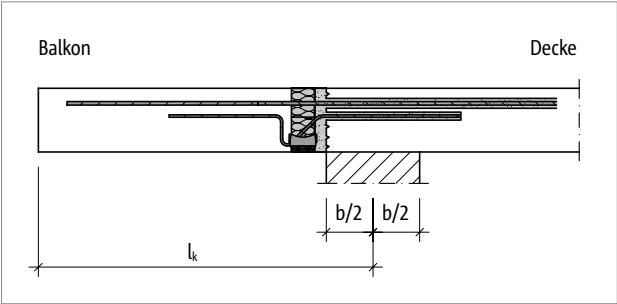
Schöck Isokorb® RT Typ K: Statisches System; direkte Lagerung
